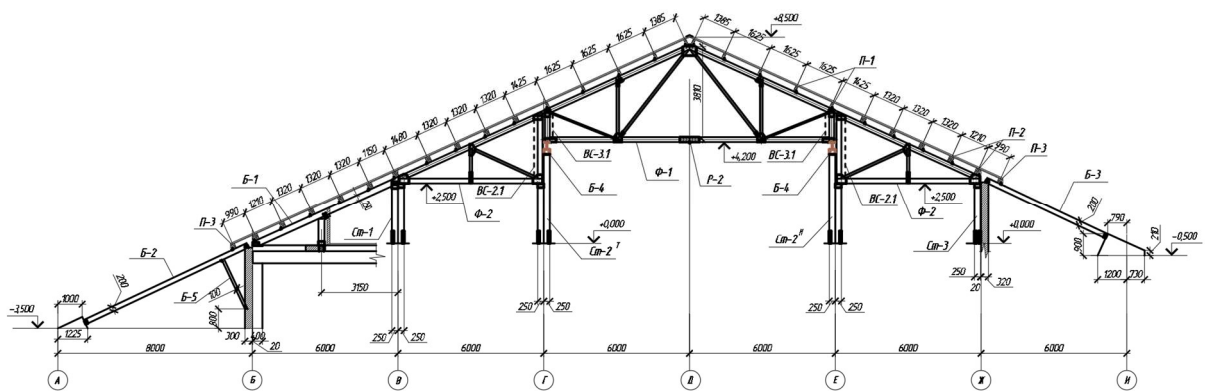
Разрез 1-1 по схеме расположения балок
